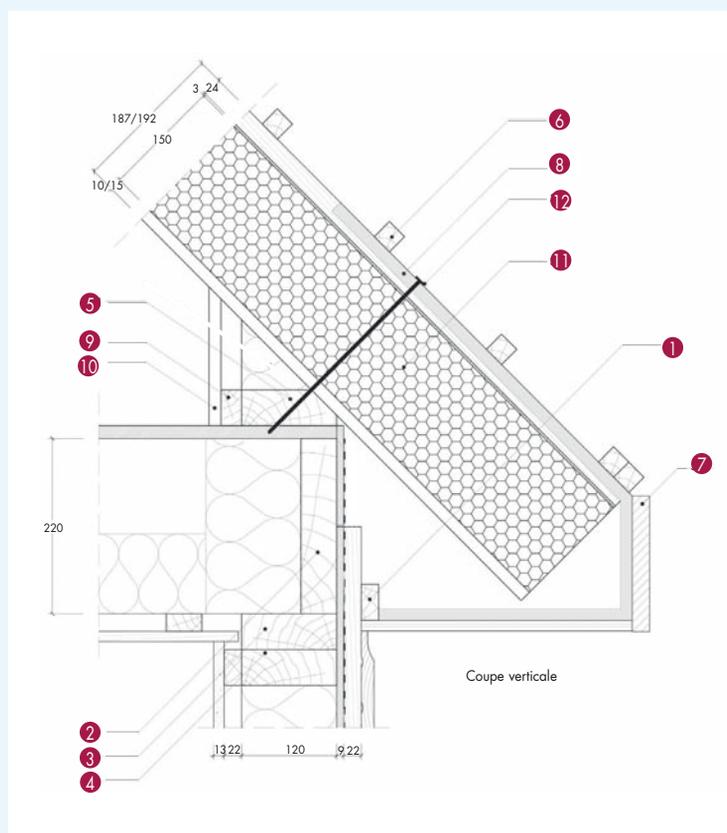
Coupe verticale - Panneau isolant sur sablière
